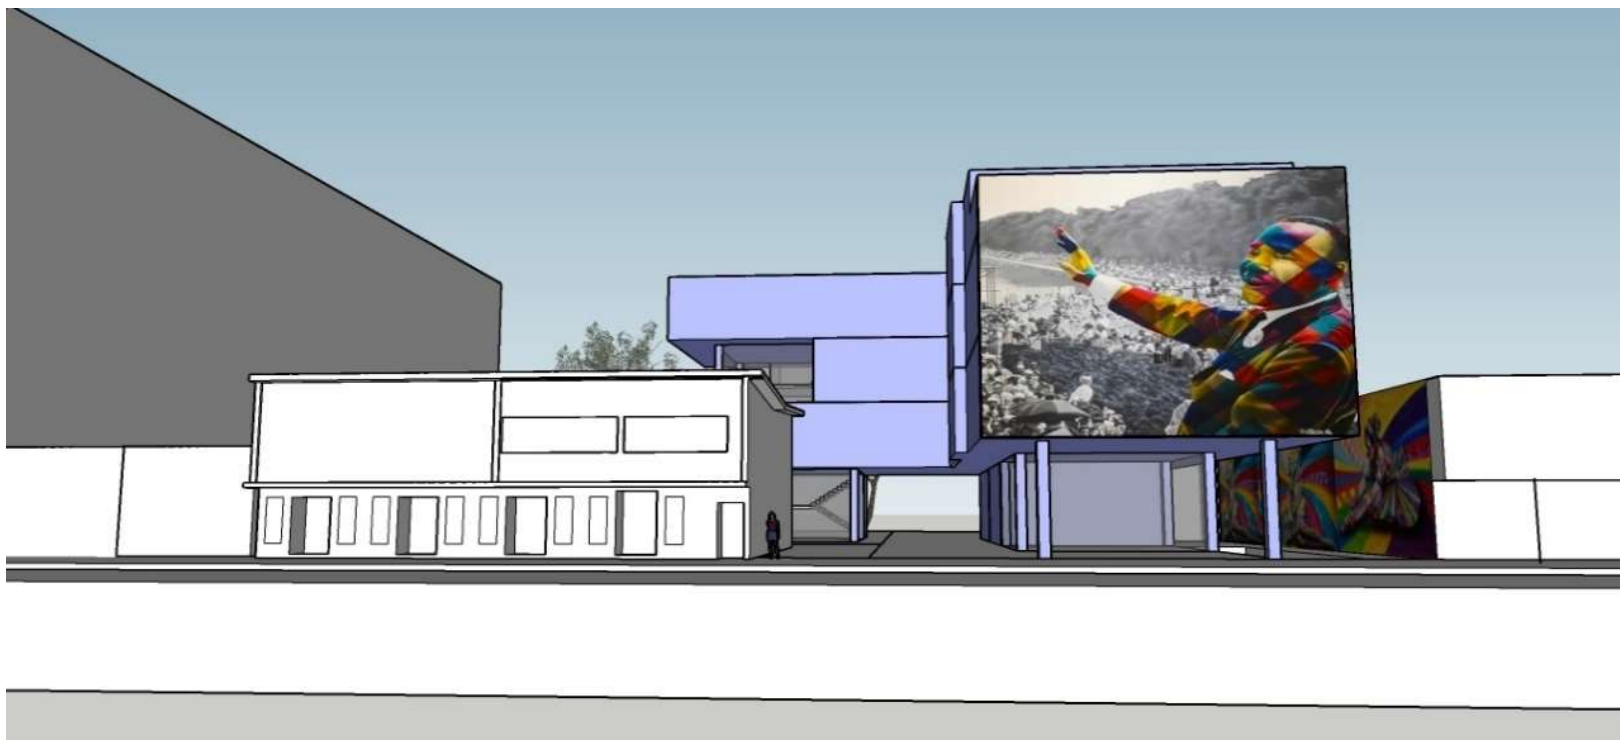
Fachada da rua Coronel Pedro Benedet com o a vista do vão de oito metros. Fonte: Arquivo pessoal
